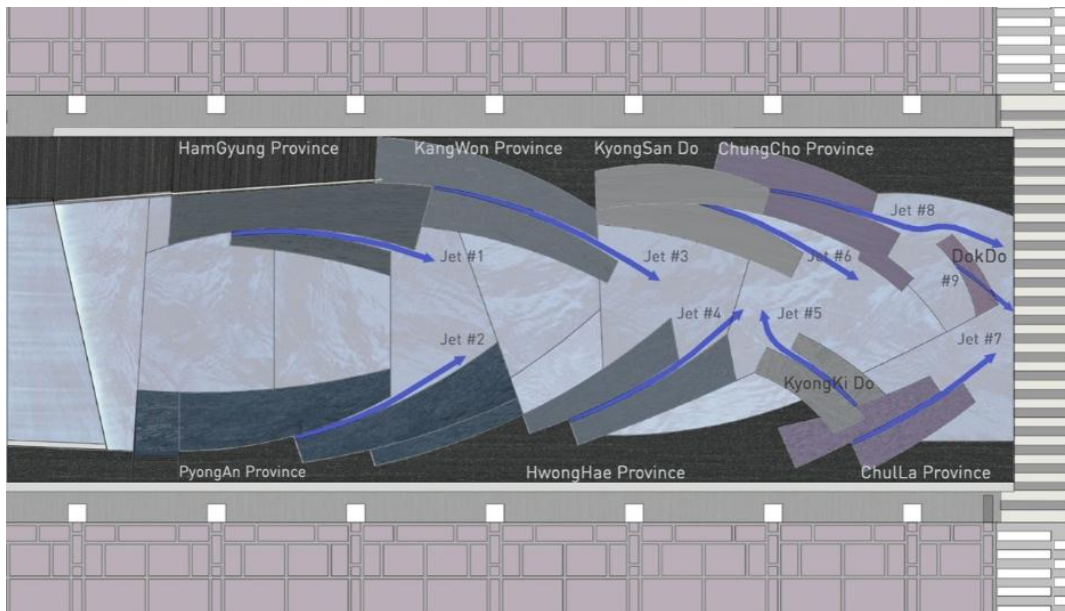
Planta del canal ChonGae (Diseño, 2011)
